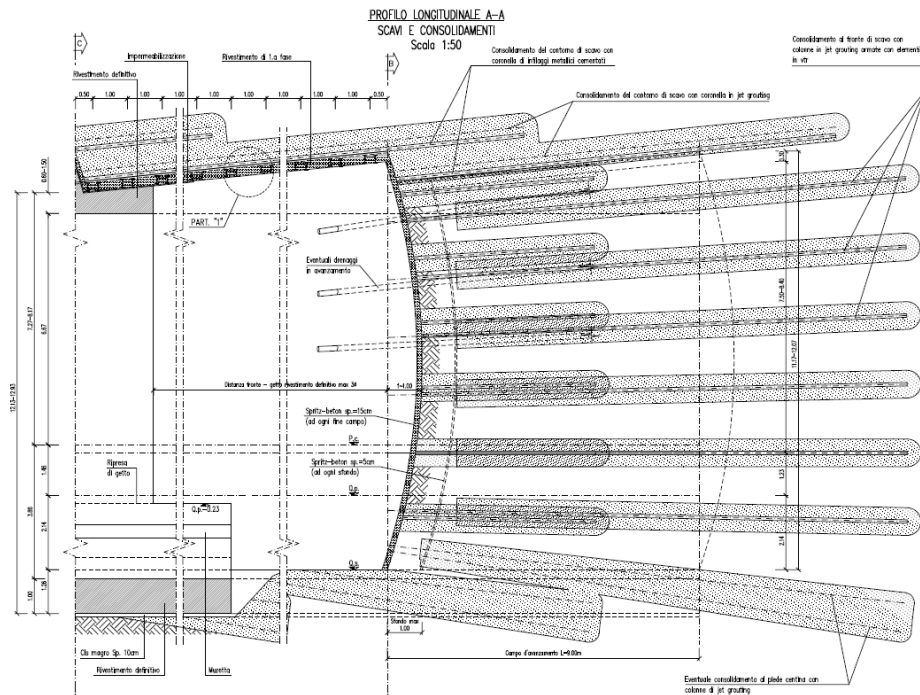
Sezione tipo C1b (profilo longitudinale)
